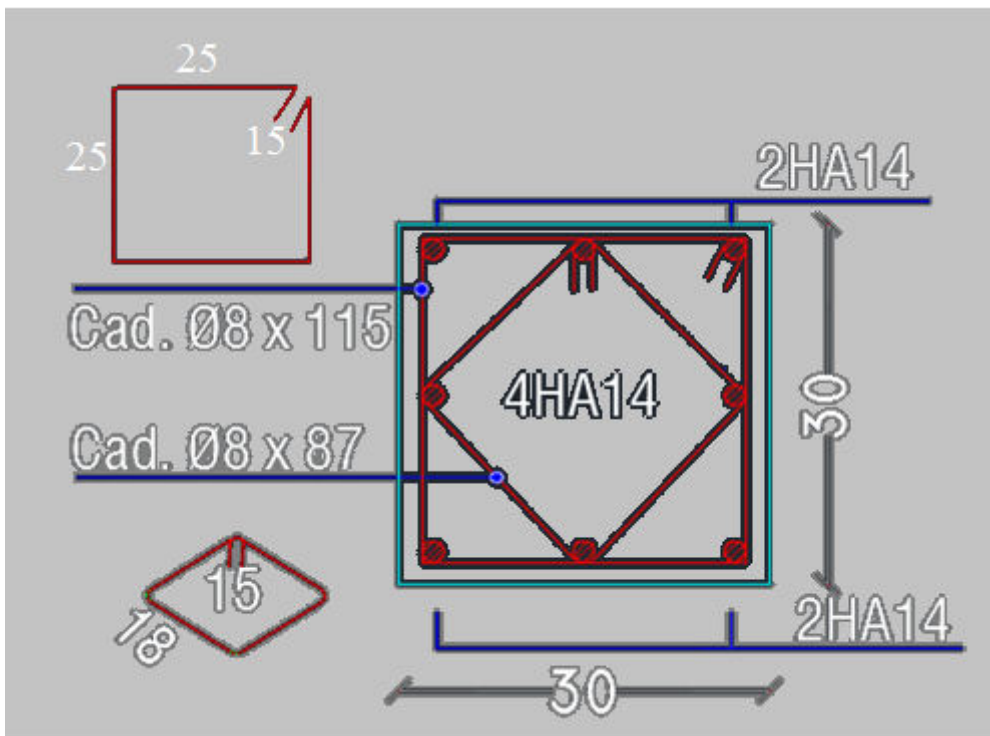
Coupe de ferrailage des poteaux 30x30 cm<sup>2</sup> (terrasse)
